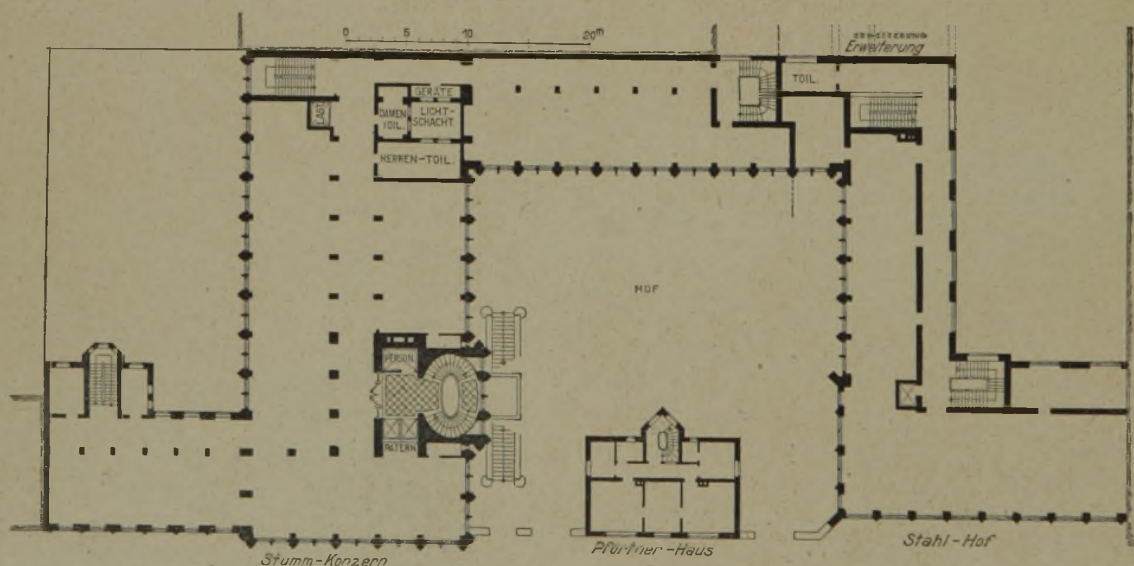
Grundriß vom 1. Obergeschoß. (1 : 600.)
